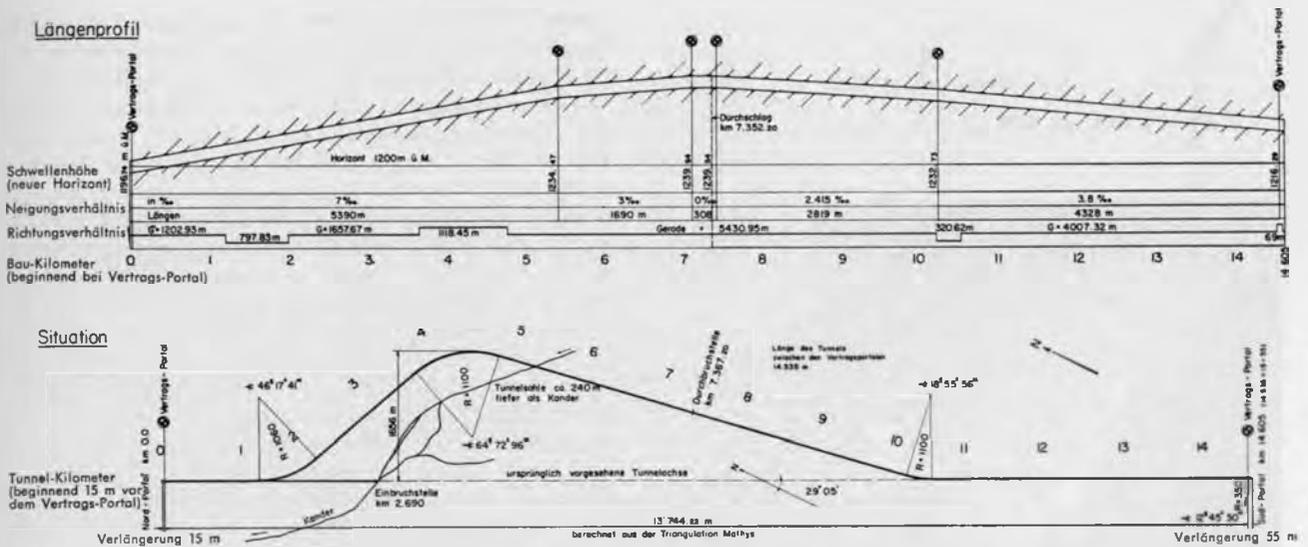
Längenprofil und Situation des Lötschbertunnels (Tunnelkilometrierung = Baukilometrierung + 15 m); Länge des Tunnels zw. den Vertragsportalen 14 535 m
